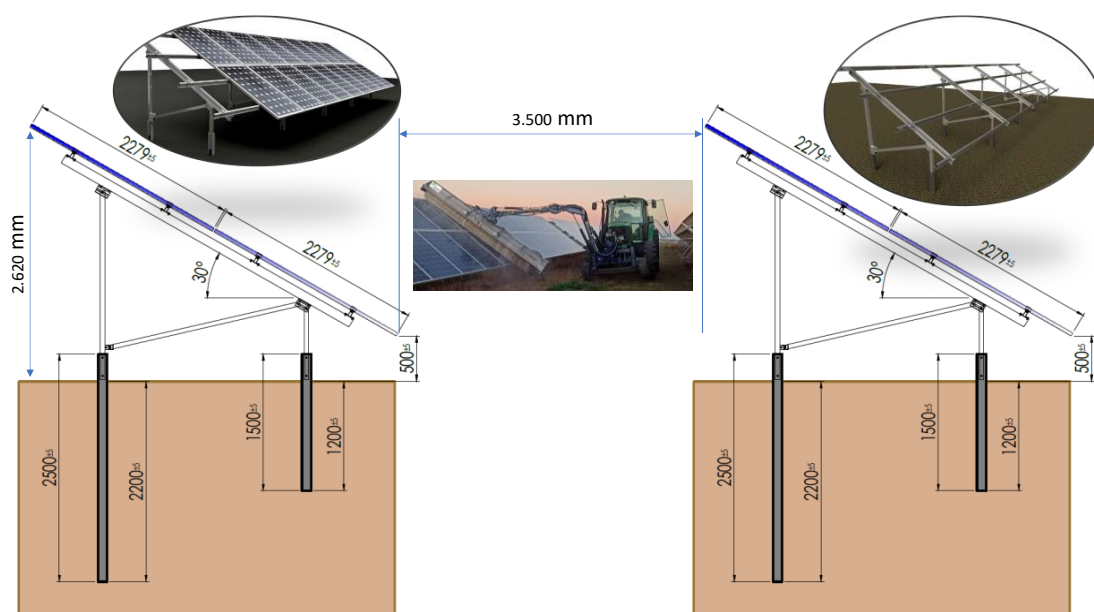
Disposición de las hileras de estructuras de soporte de los paneles en la planta fotovoltaica
